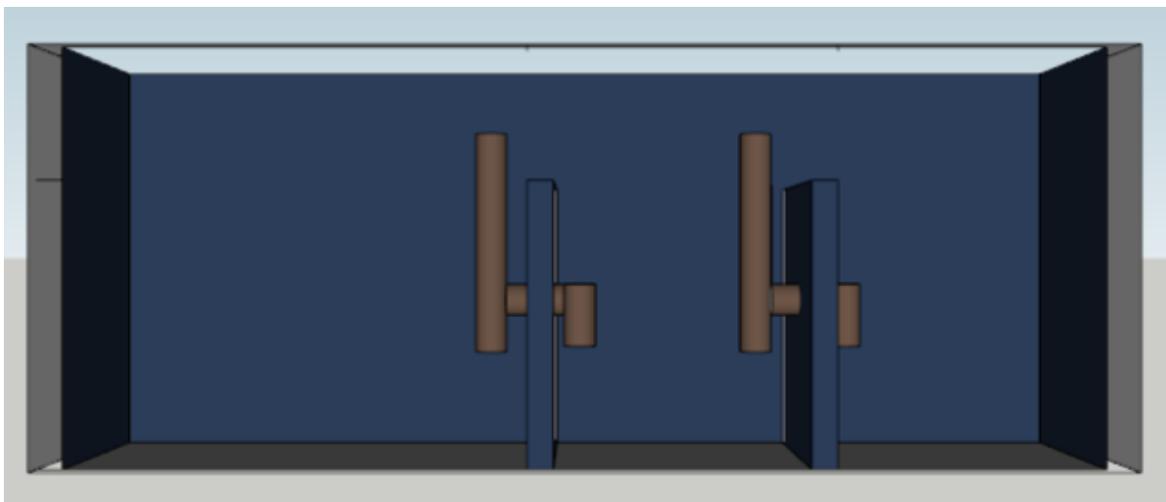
Trampa de grasa Italcol planta 1 vista 3D, perfil
